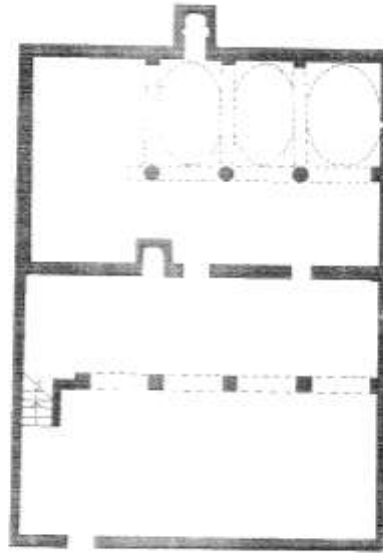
مسقط أفقي لمسجد سلطان الخميساني
